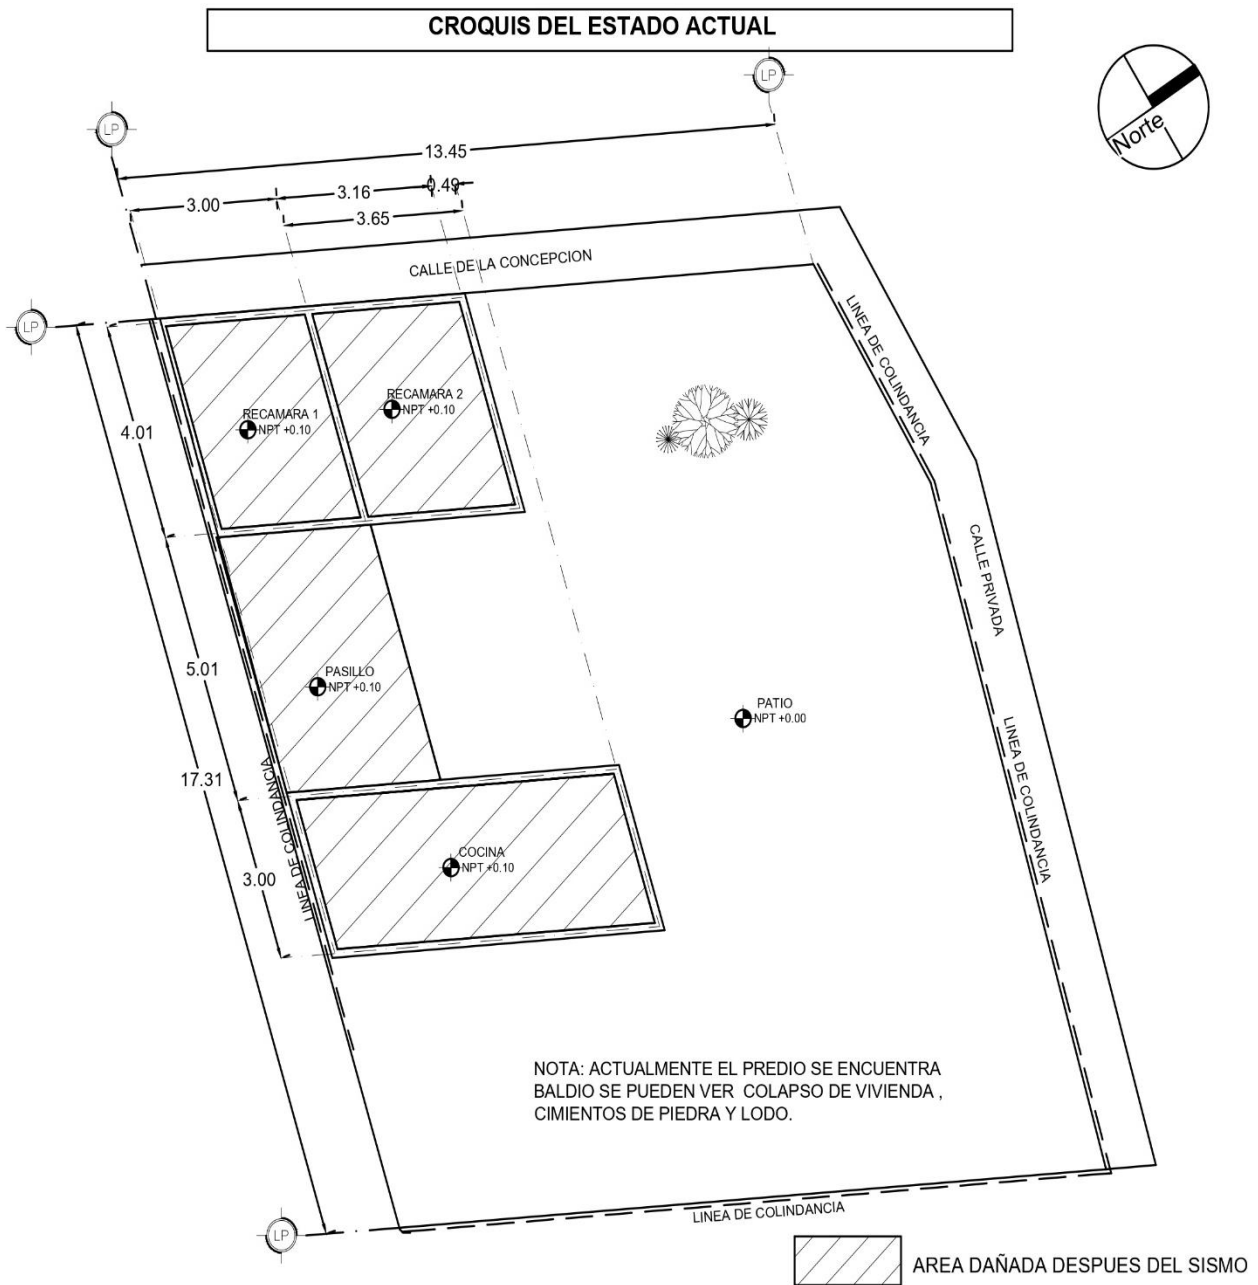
Planta del área a intervenir. (18.952114, -98.979683).
